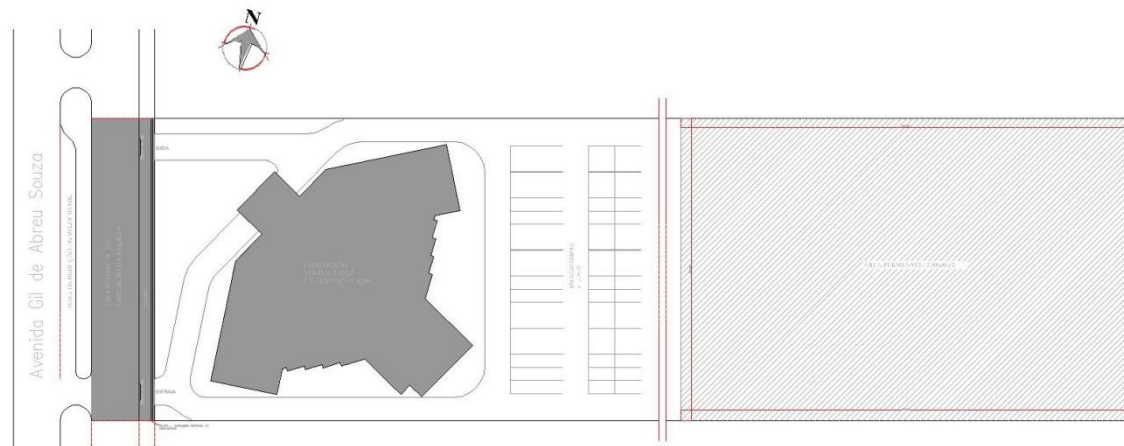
Implantação indicando faixa reservada para duplicação da via, estacionamento e área permeável. Fonte: Projeto Arquitetônico.
